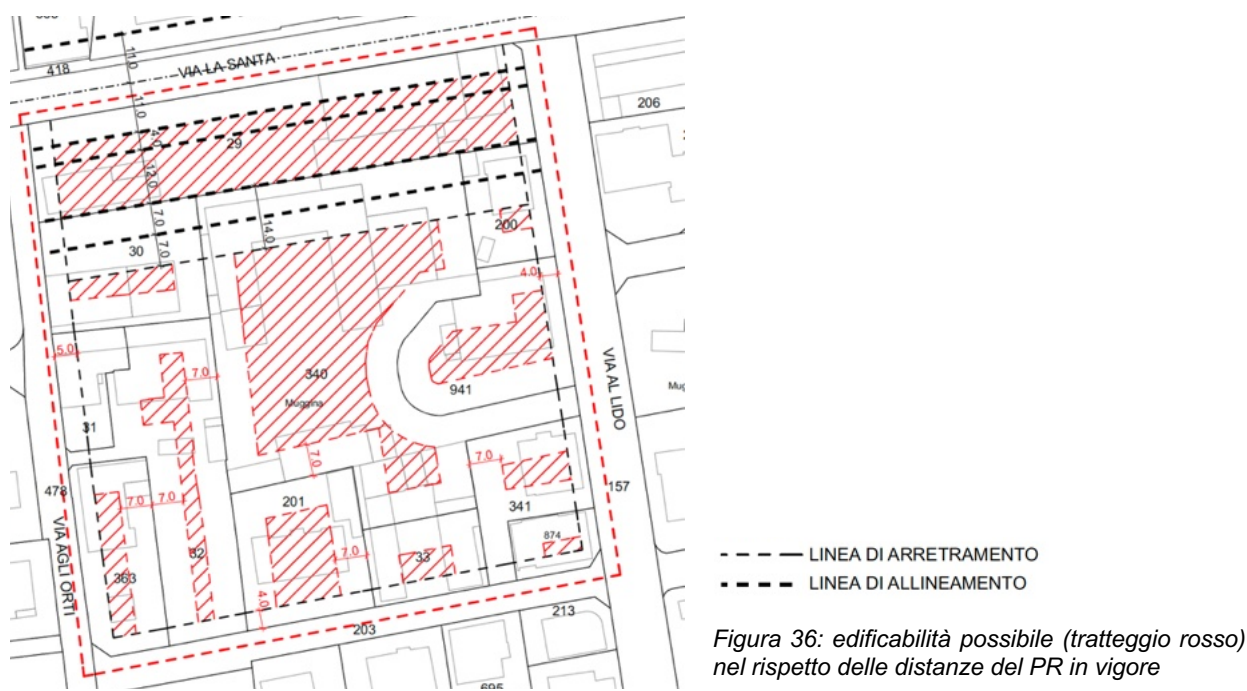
edificabilità possibile (tratteggio rosso) nel rispetto delle distanze del PR in vigore
